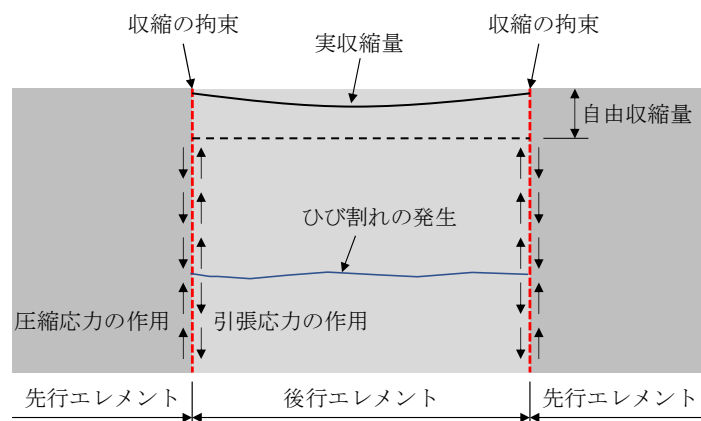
後行エレメントの温度ひび割れ発生メカニズム¹⁾
